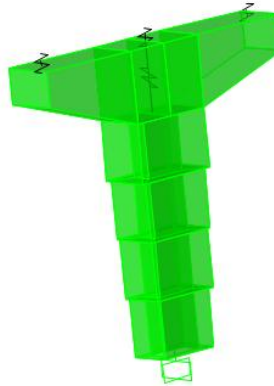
Modelo del pilar central empotrada en la base y con vínculo articulado en el sentido longitudinal
